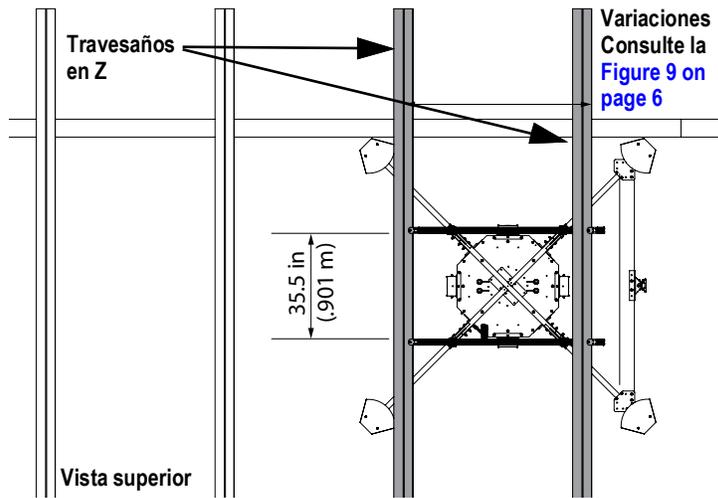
Vista superior de la configuración del travesaño de techo en Z
